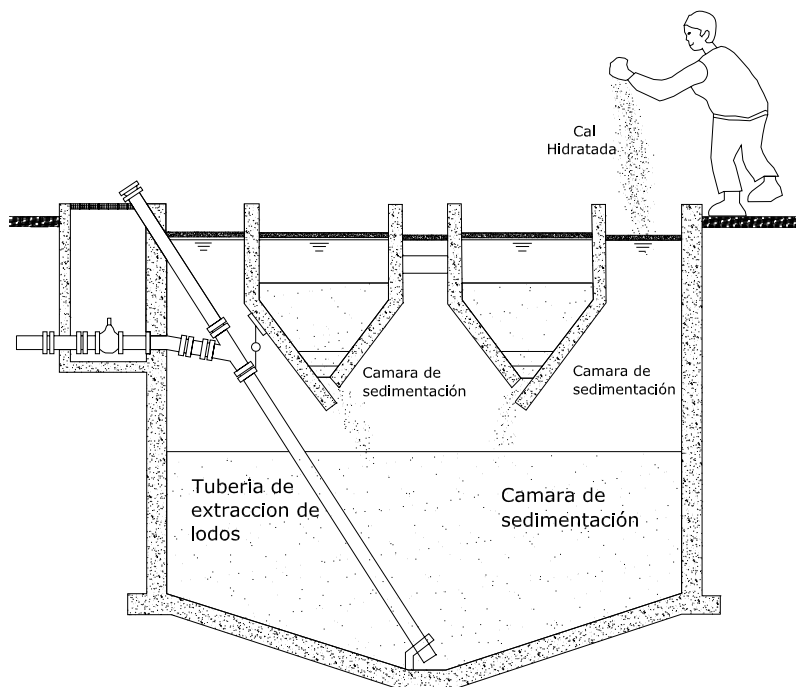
Operador colocando cal hidratada en las zonas de ventilación de un tanque Imhoff
